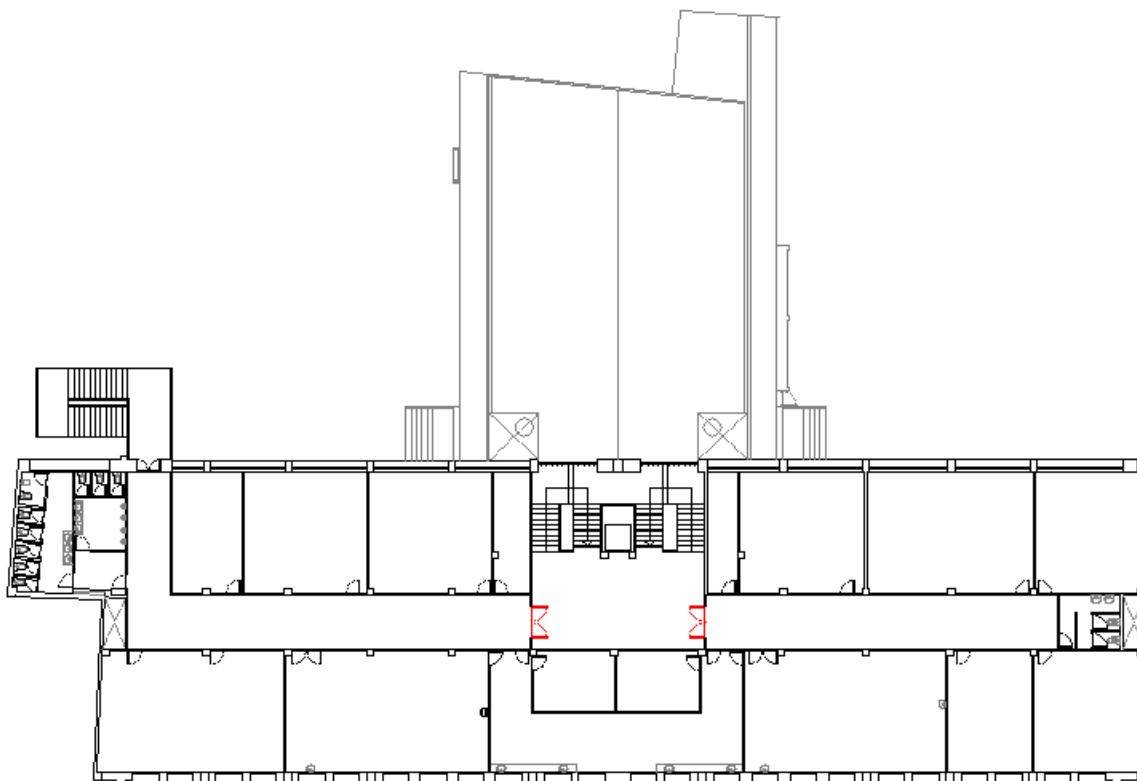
Propuestas de actuación en puertas planta tercera. Fuente: Elaboración propia.
